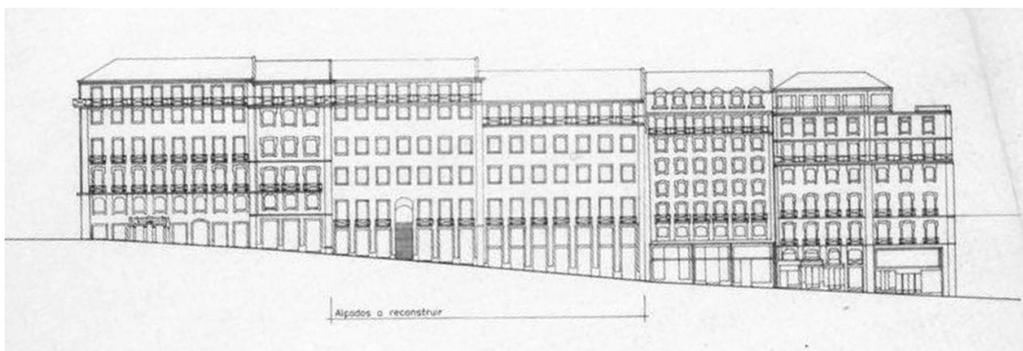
Plano Pormenor da Zona Sinistrada do Chiado - Fachada da Rua do Carmo do Bloco B
